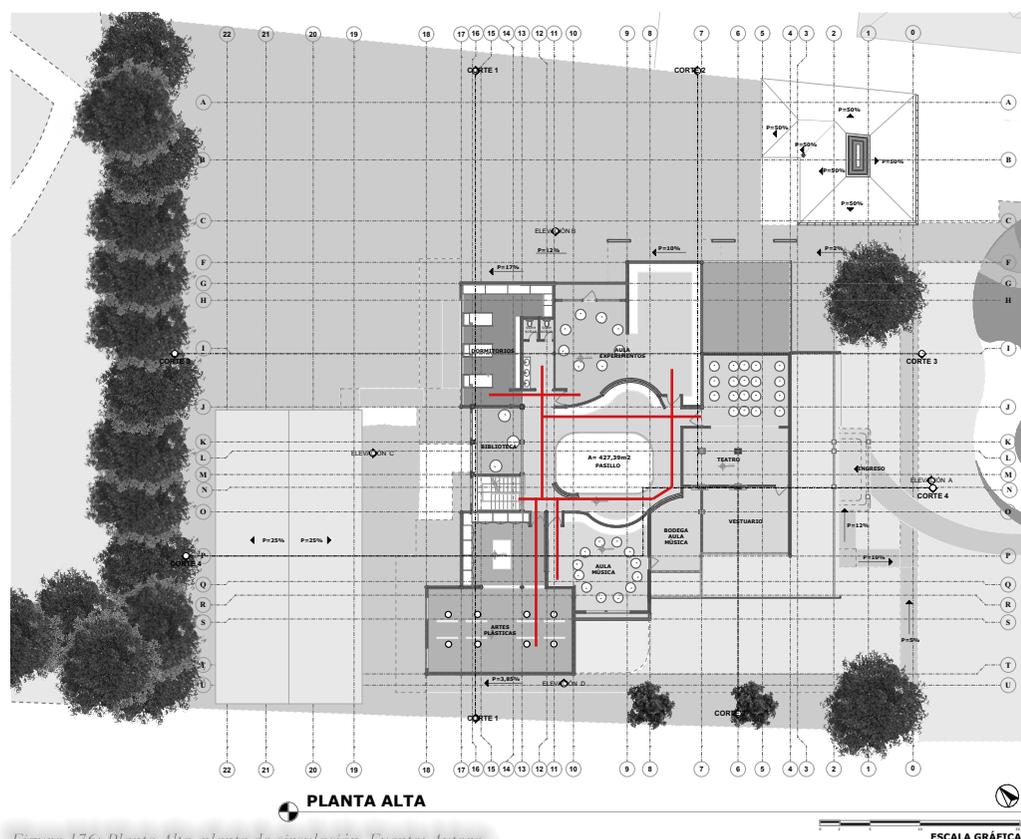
Planta Alta, planta de circulación. Fuente: Autora.
